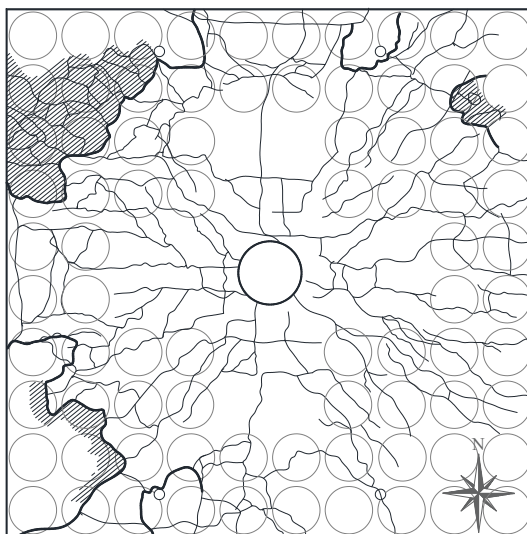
Mapa de fissuração da laje BD3
